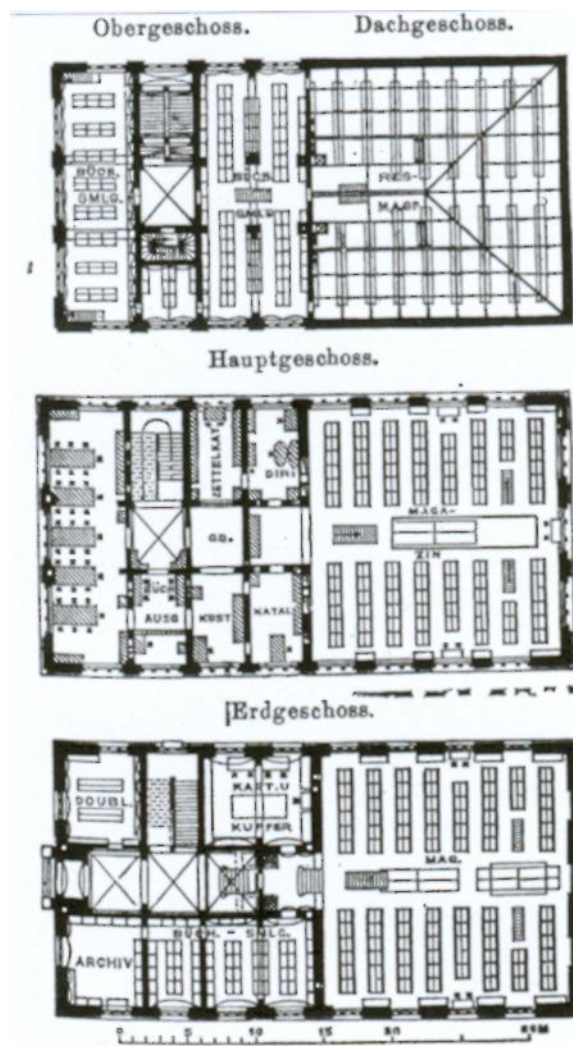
Grundrisse des Erd- und Hauptgeschosses und jeweils die Hälfte vom Ober- und Dachgeschoss
